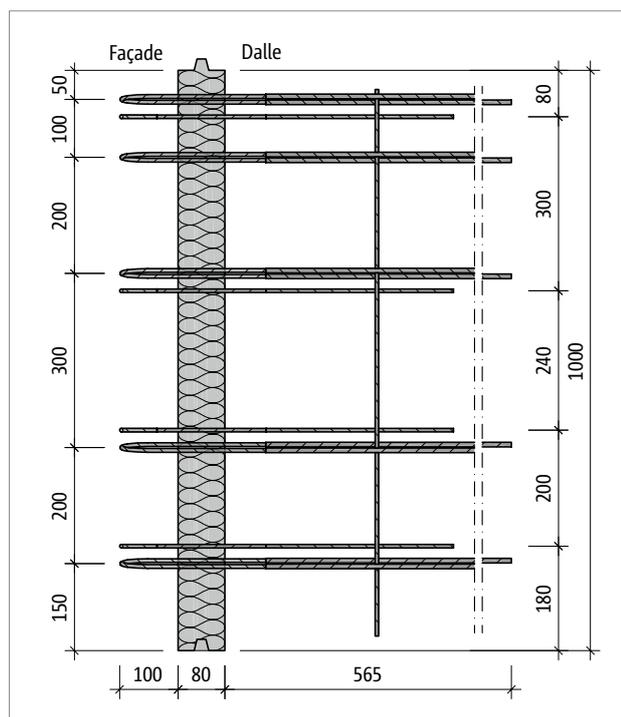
Schöck Rutherma® T type DF-V3-LR100 : vue en plan du produit
